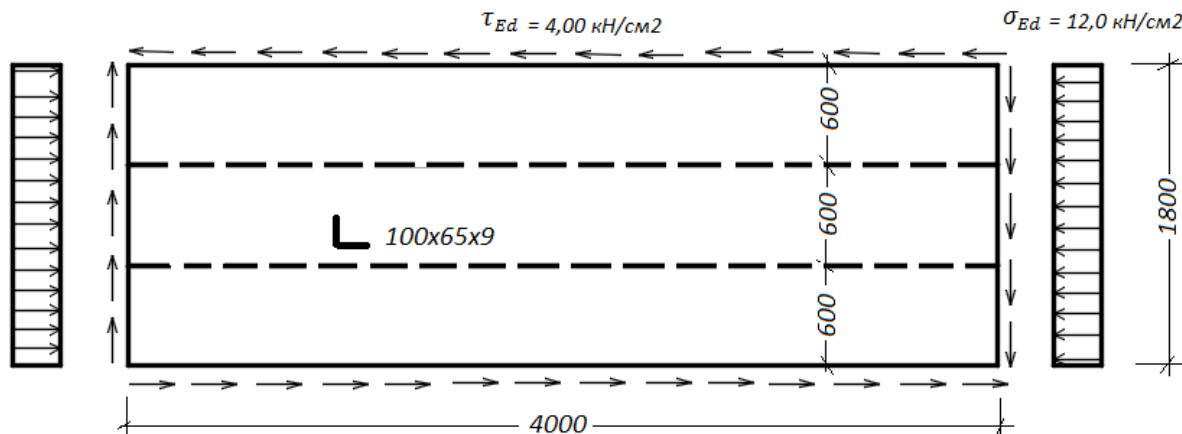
Конструктивная схема пластины с действующими напряжениями
